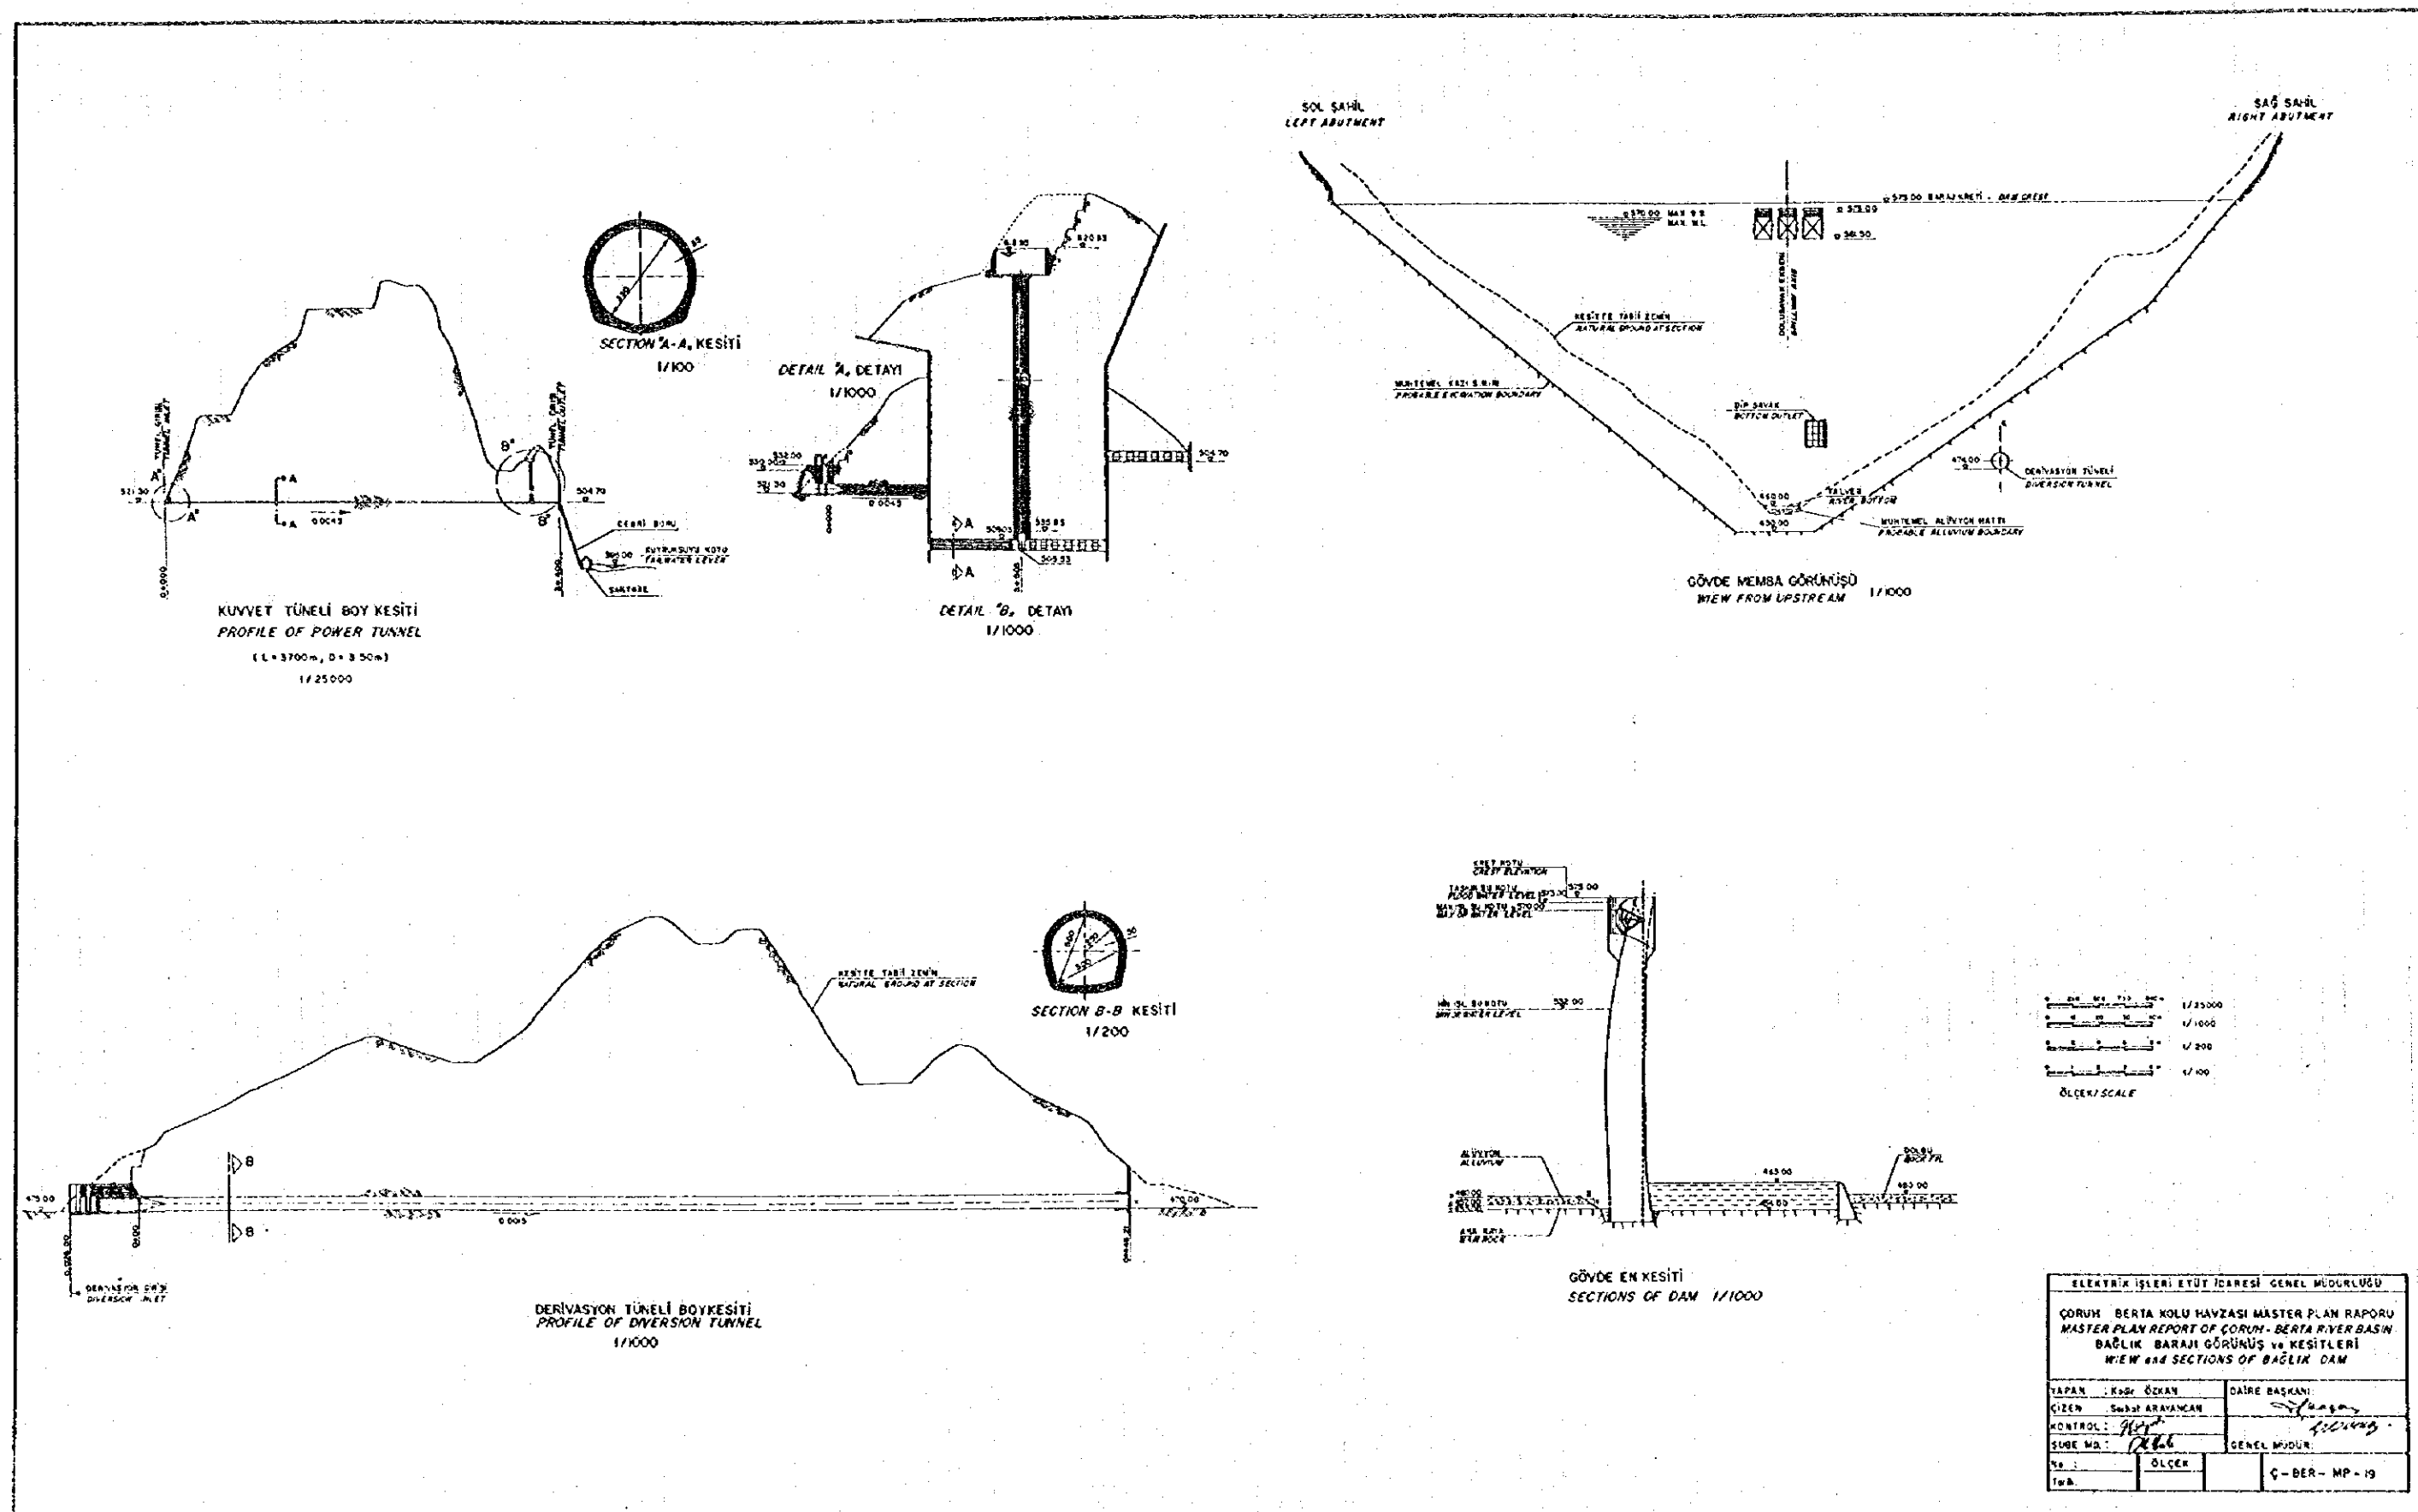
パーリックプロジェクトダム縦横断面図及び導水路・仮排水路縦断面図
